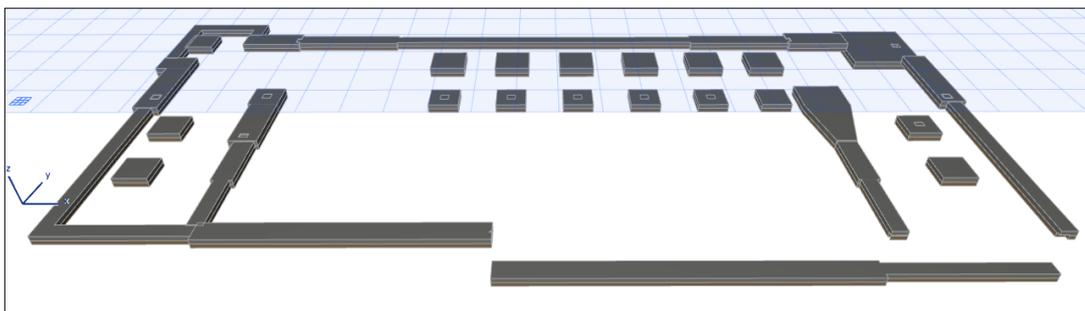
Alzado planta de cimentación en 3D de maqueta inicial
